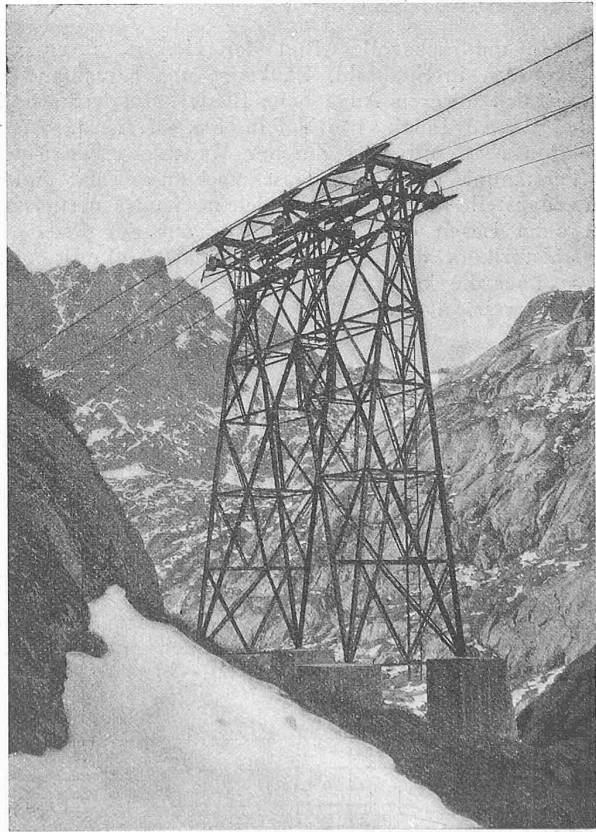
Eiserner Pfeiler mit drei Auflagern der Luftseilbahn G-F von der Kiesaufbereitungs- nach der Betonzubereitungs-Anlage.
